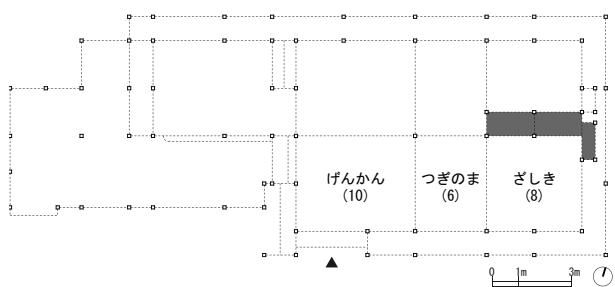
Ms 家住宅復元平面図（明治 37 年 6 月）
